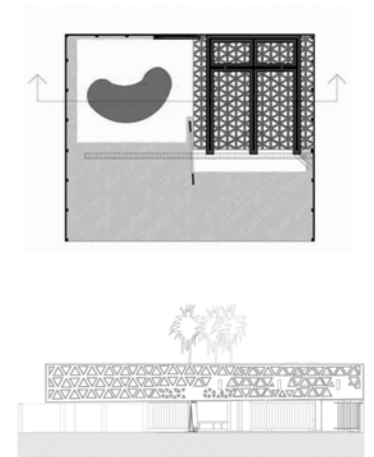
Planta, Corte Quincho tia Coral Fuente: Gabinete Arquitectura
